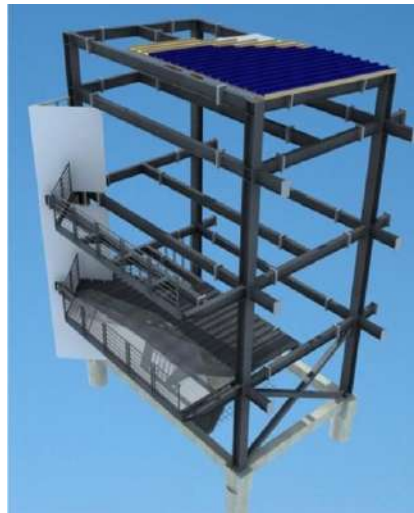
sistema constructivo pórticos metálicos alma llena contemporáneo. Edificios P y Q
